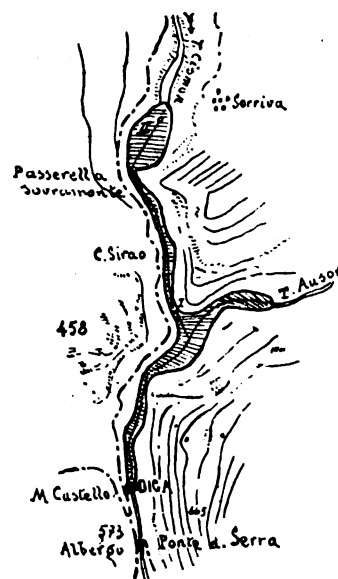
Planimetria del lago serbatoio. Scale 1:82.000.
